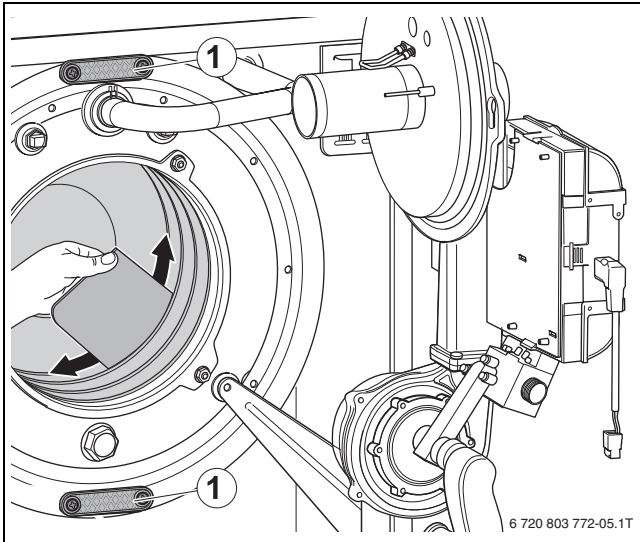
Heizgasspalte mit Reinigungsspachtel reinigen
